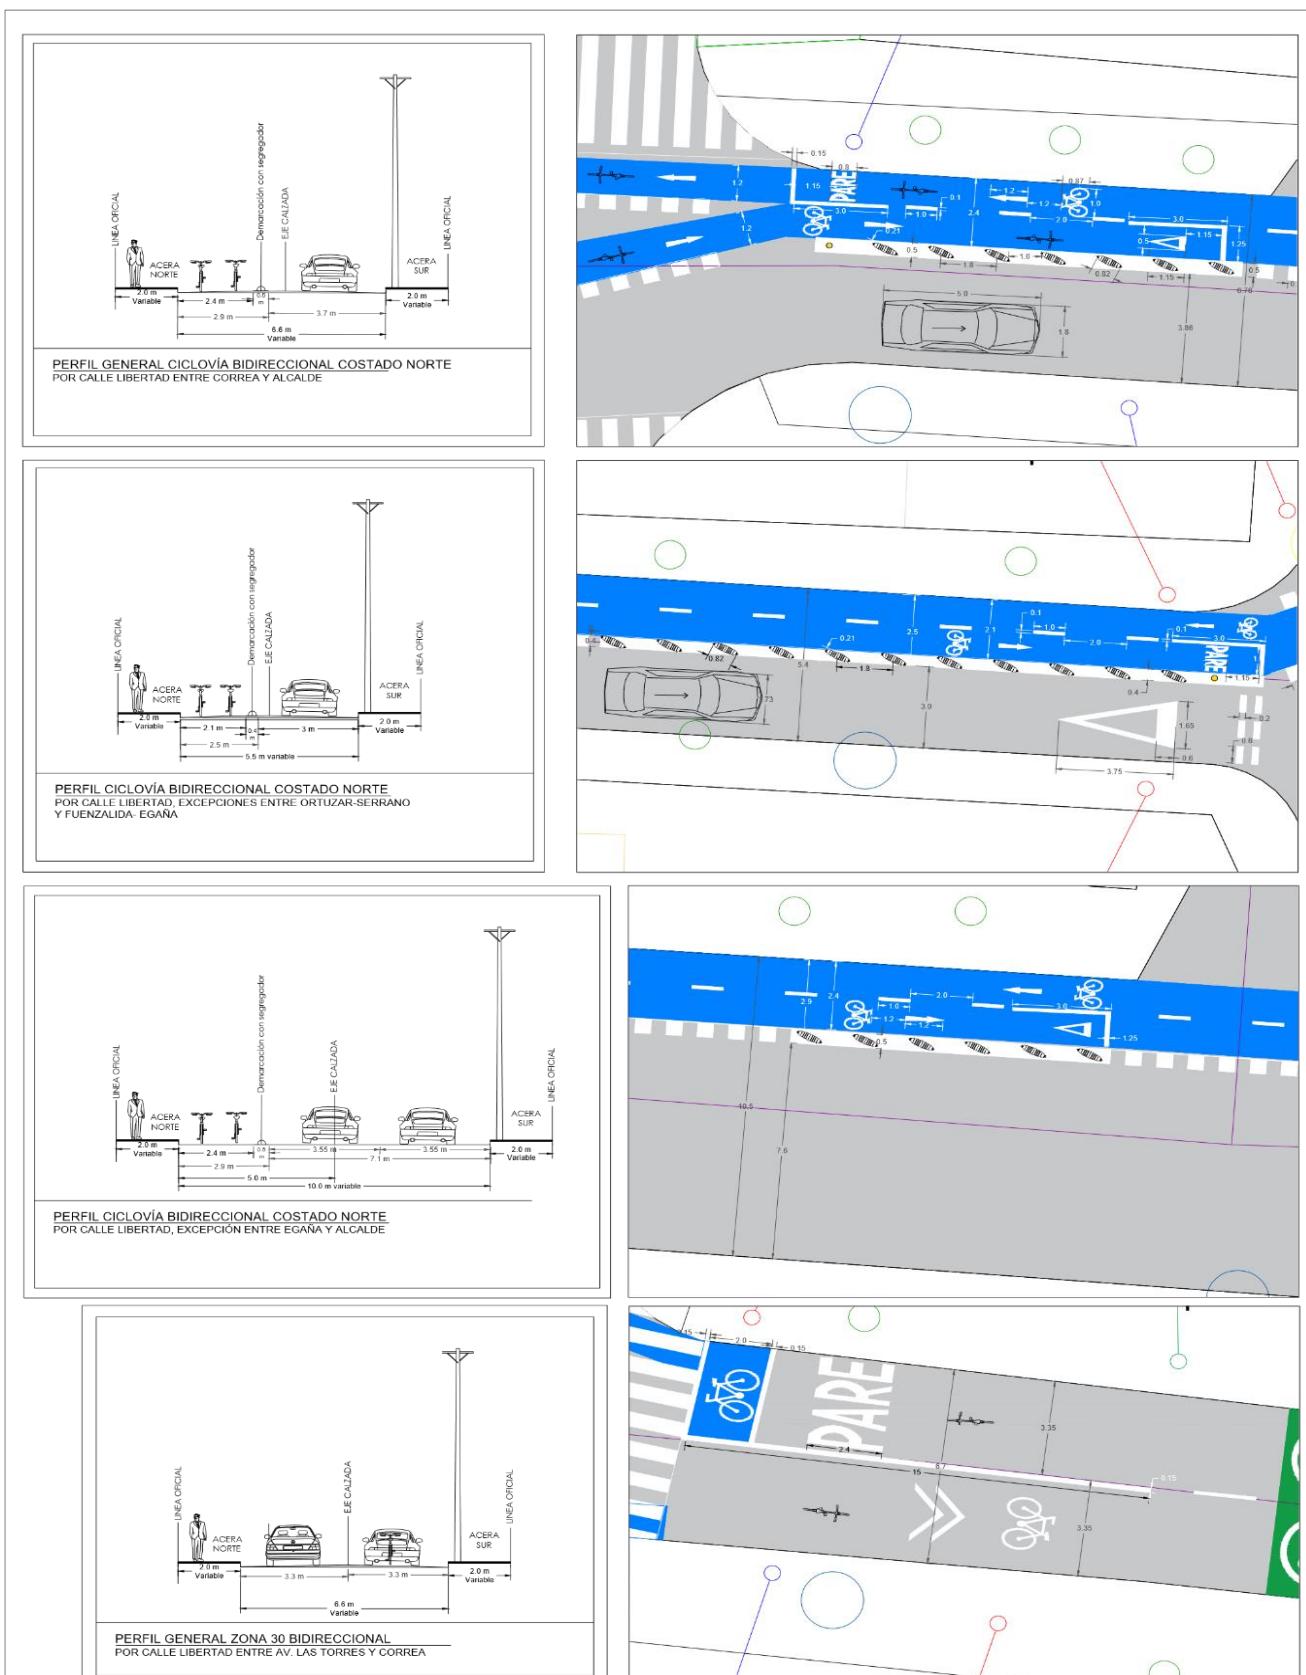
Plano de perfiles y acercamiento a detalles vía calle Libertad. Elaboración propia.
